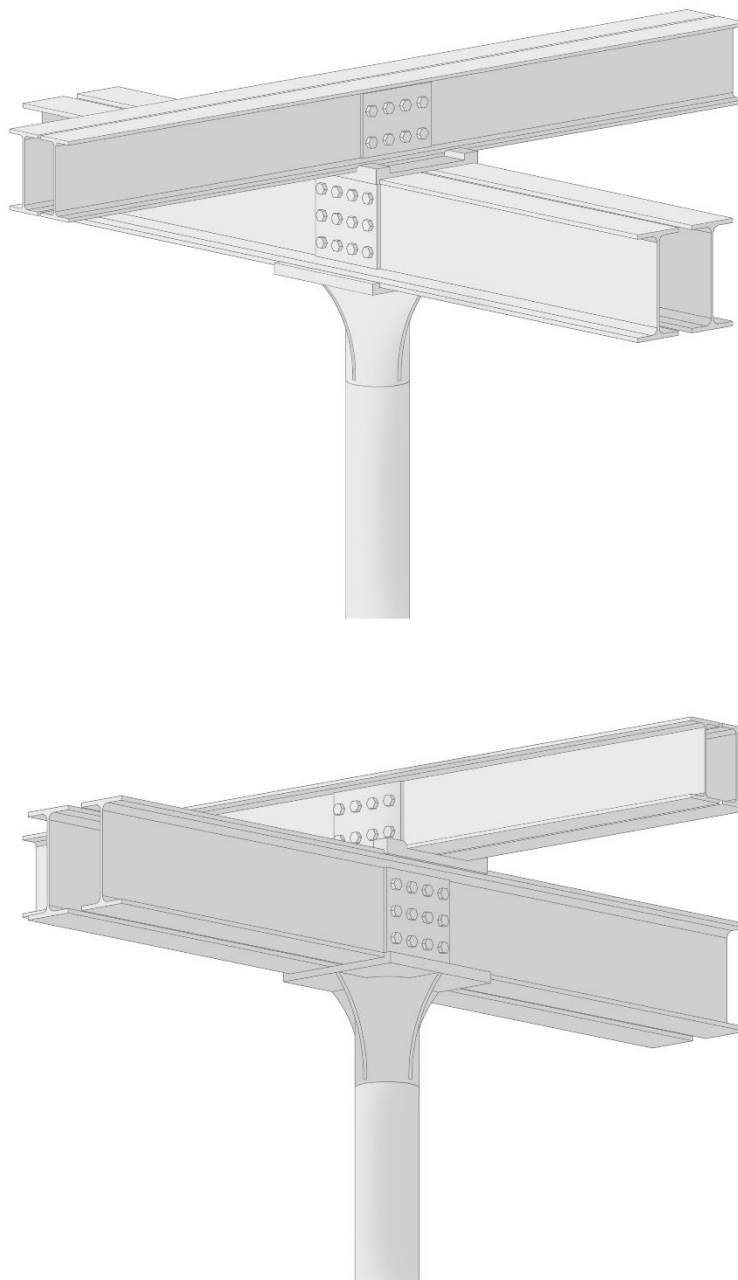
3D dettaglio nodi trave-pilastro
